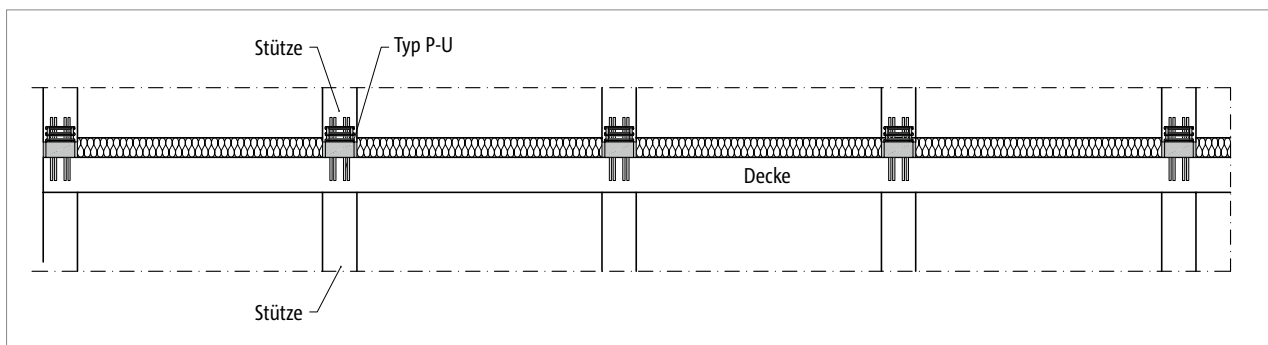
Schöck Sconnex® Typ P-U: Stützenanschluss an die darunterliegende Decke
